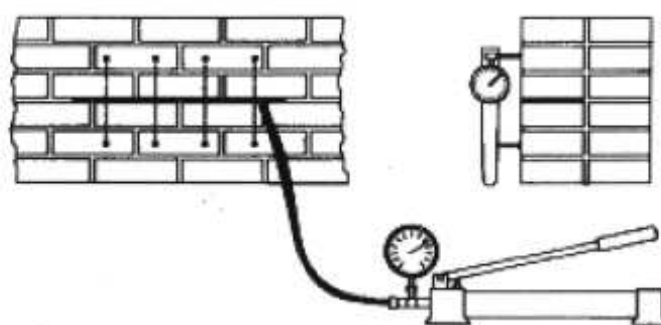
Schema di sistemazione e preparazione della prova
